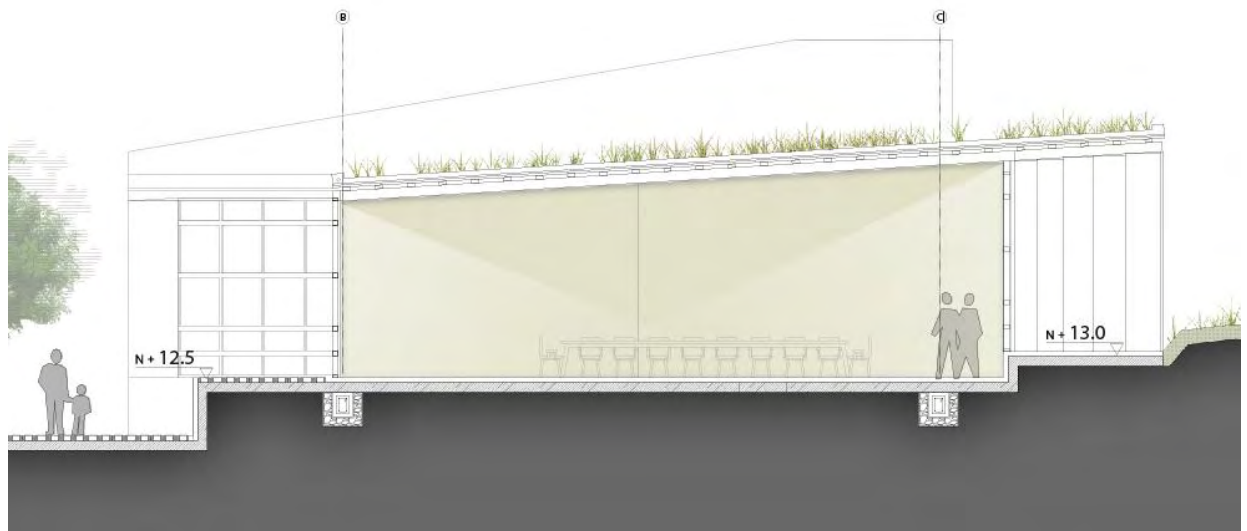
Corte B-B4 – Fuente: Elaboración Propia
